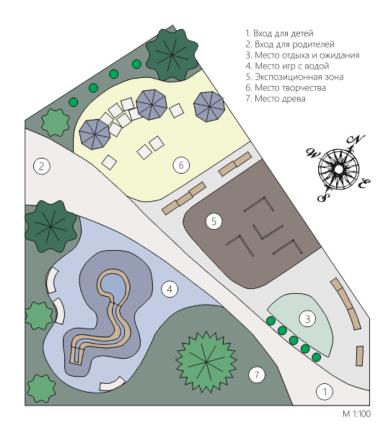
Разработанный генеральный план площадки интерактивной площадки
